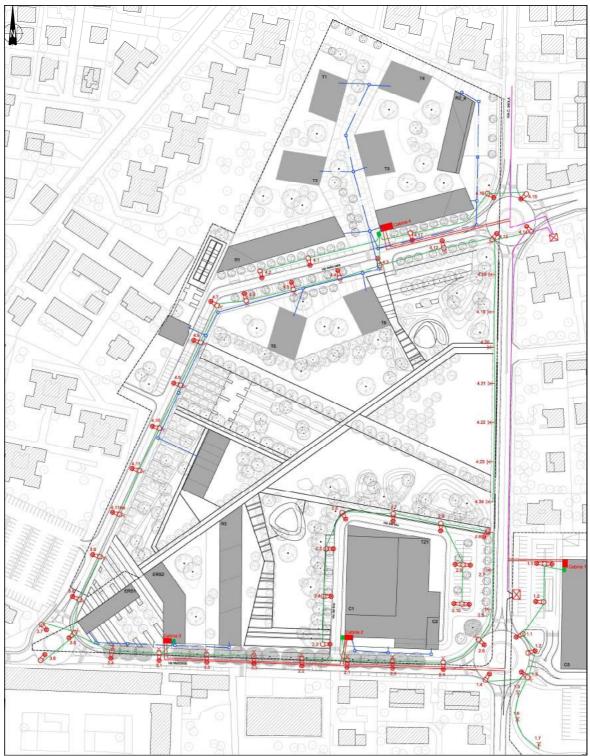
Planimetria rete elettrica e illuminazione in progetto
